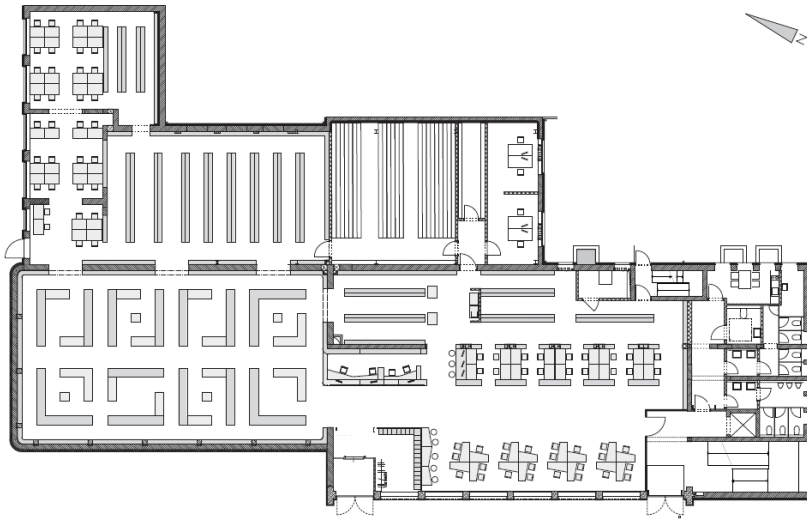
Grundriss EG mit der Bibliothek der Hochschule Anhalt, Standort Dessau, 2010. © ReinerBeckerArchitekten BDA, Berlin.
